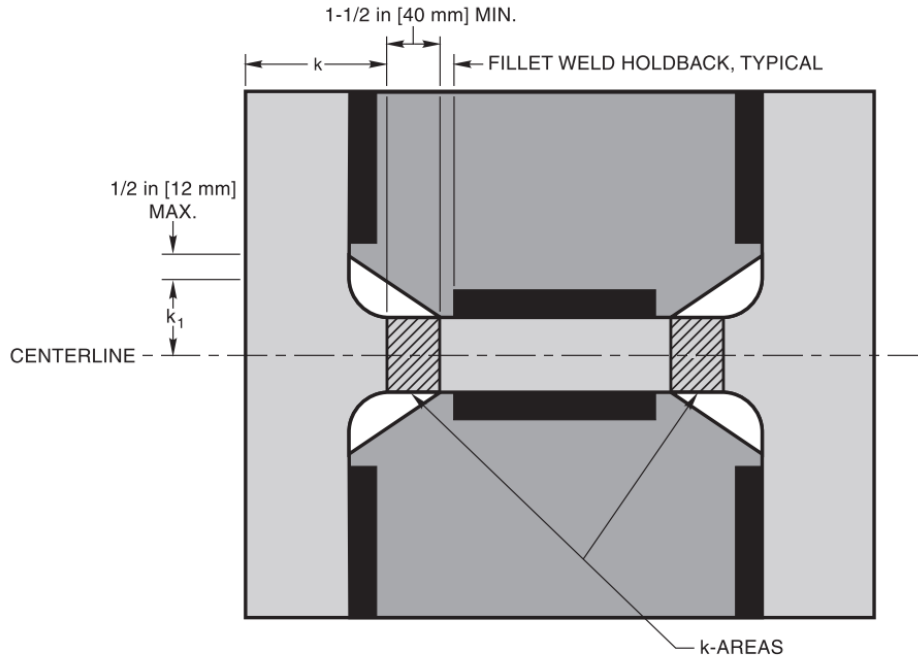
Vista en planta de disposición típica de cortes de esquina en planchas de continuidad. Fuente: AWS D1.8-16
